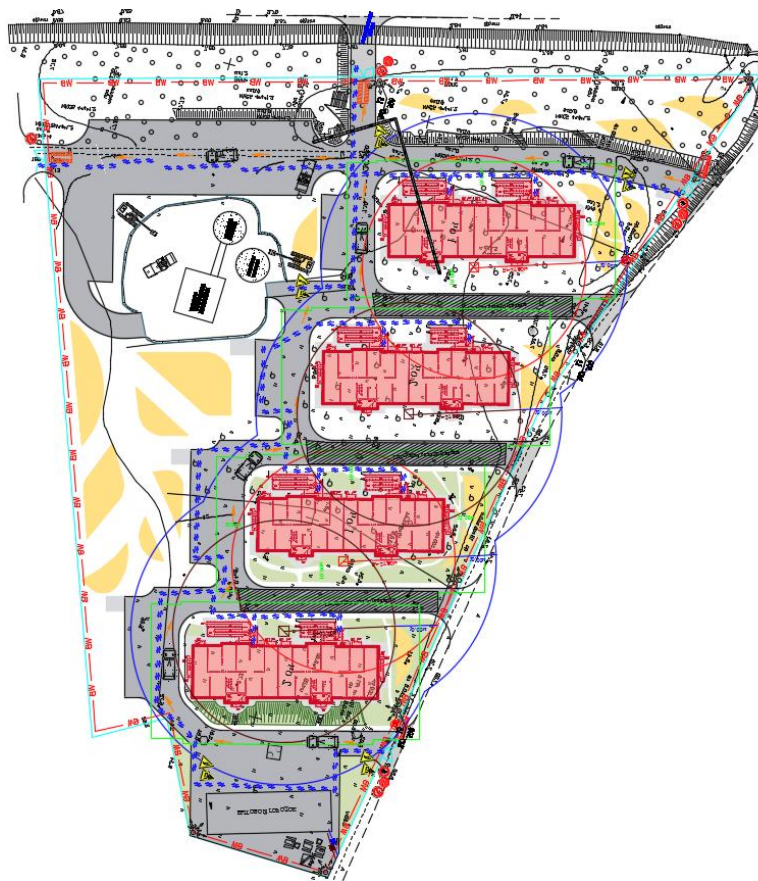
Схема стройгенплана комплексной застройки 4 девятиэтажных жилых домов при параллельном их возведении
